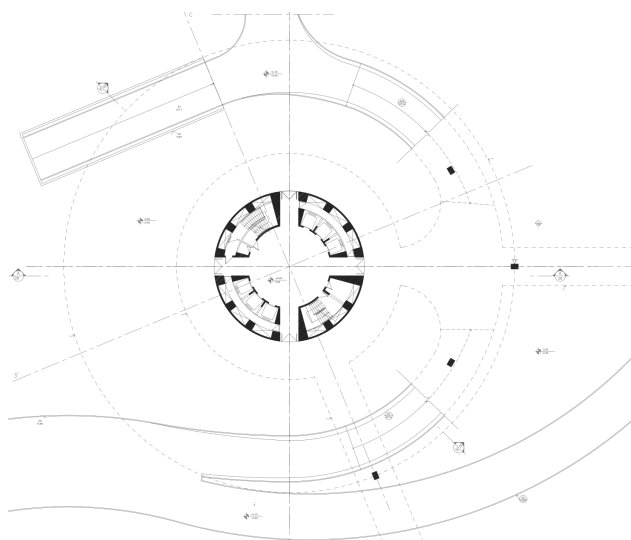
Planta do térreo, bloco A; Fonte: Arquivo da PGR
